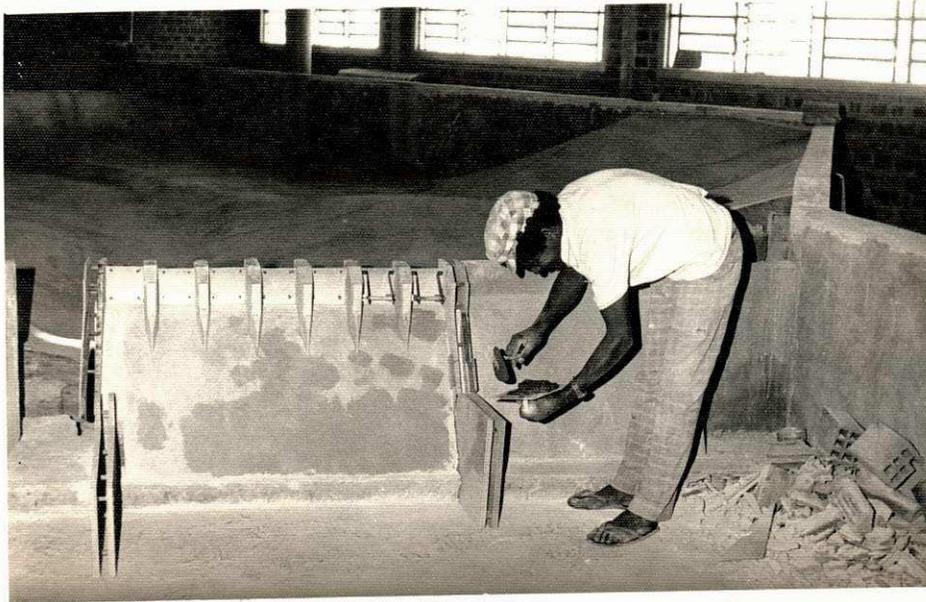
CONSTRUÇÃO DO VERTEDOR
